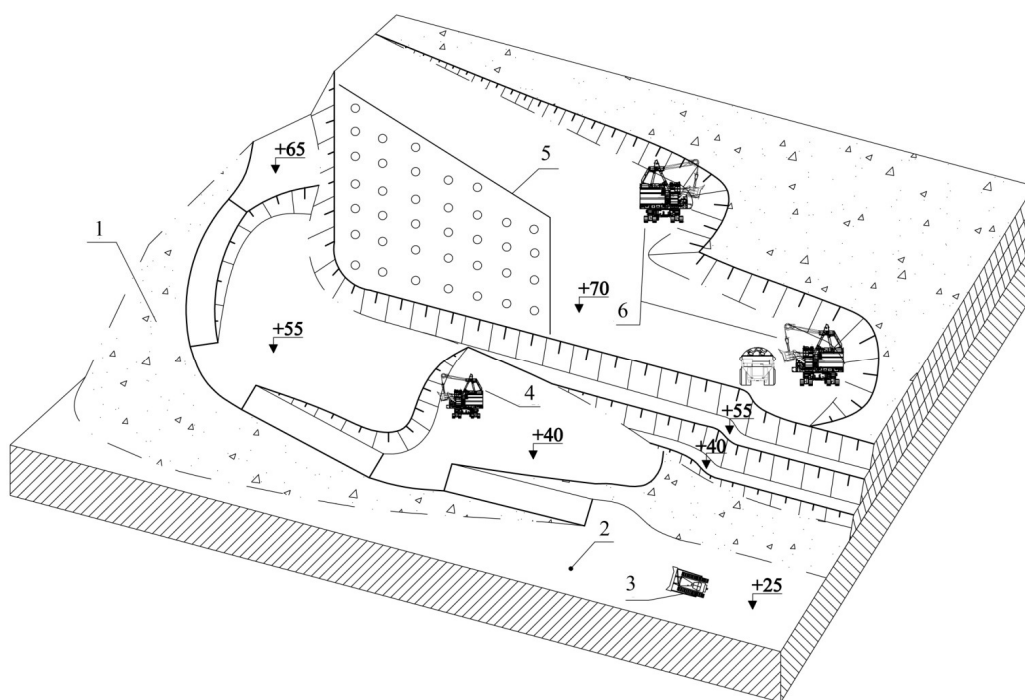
Схема разноса ВНБ: 1 – насыпная призма из взорванных вскрышных пород; 2 – улавливающая площадка в основании нерабочего борта; 3 – бульдозер для формирования системы съездов; 4 – экскаватор, осуществляющий формирование рабочих площадок на насыпной призме; 5 – контур блока опережающего бурения; 6 – экскаваторы на расконсервации ВНБ
